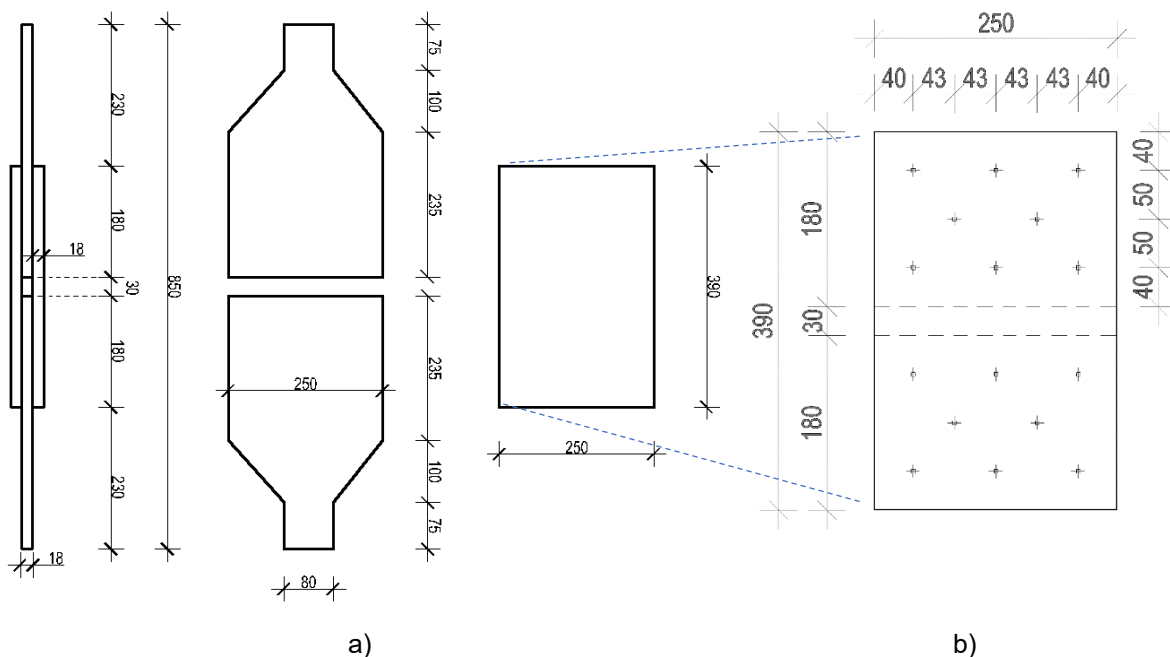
a) Dimensões dos provetes de ligações pregadas e aparafusadas. b) Esquema de colocação dos conetores metálicos (Dimensões em mm)
